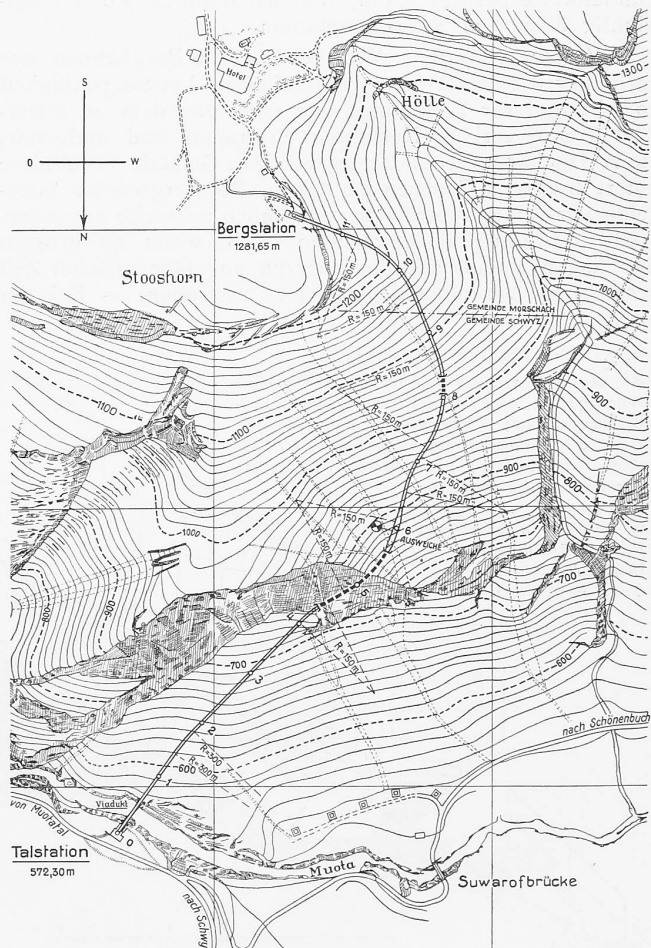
Lageplan der Seilbahn Schwyz-Stoos. — Masstab 1 : 10 000.
